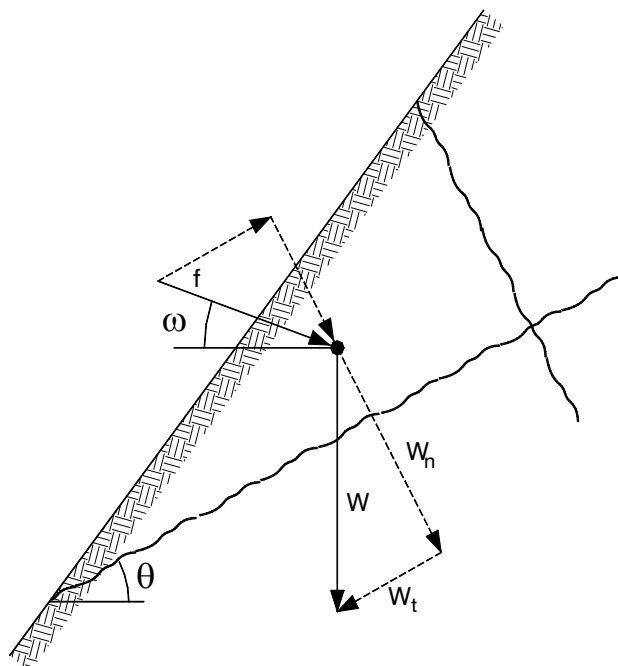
Section verticale contenant la ligne de pendage du plan de glissement d'un tétraèdre de poids propre W découpé à la paroi d'une excavation au centre de gravité duquel agit une force f dirigée vers le plan de glissement.
